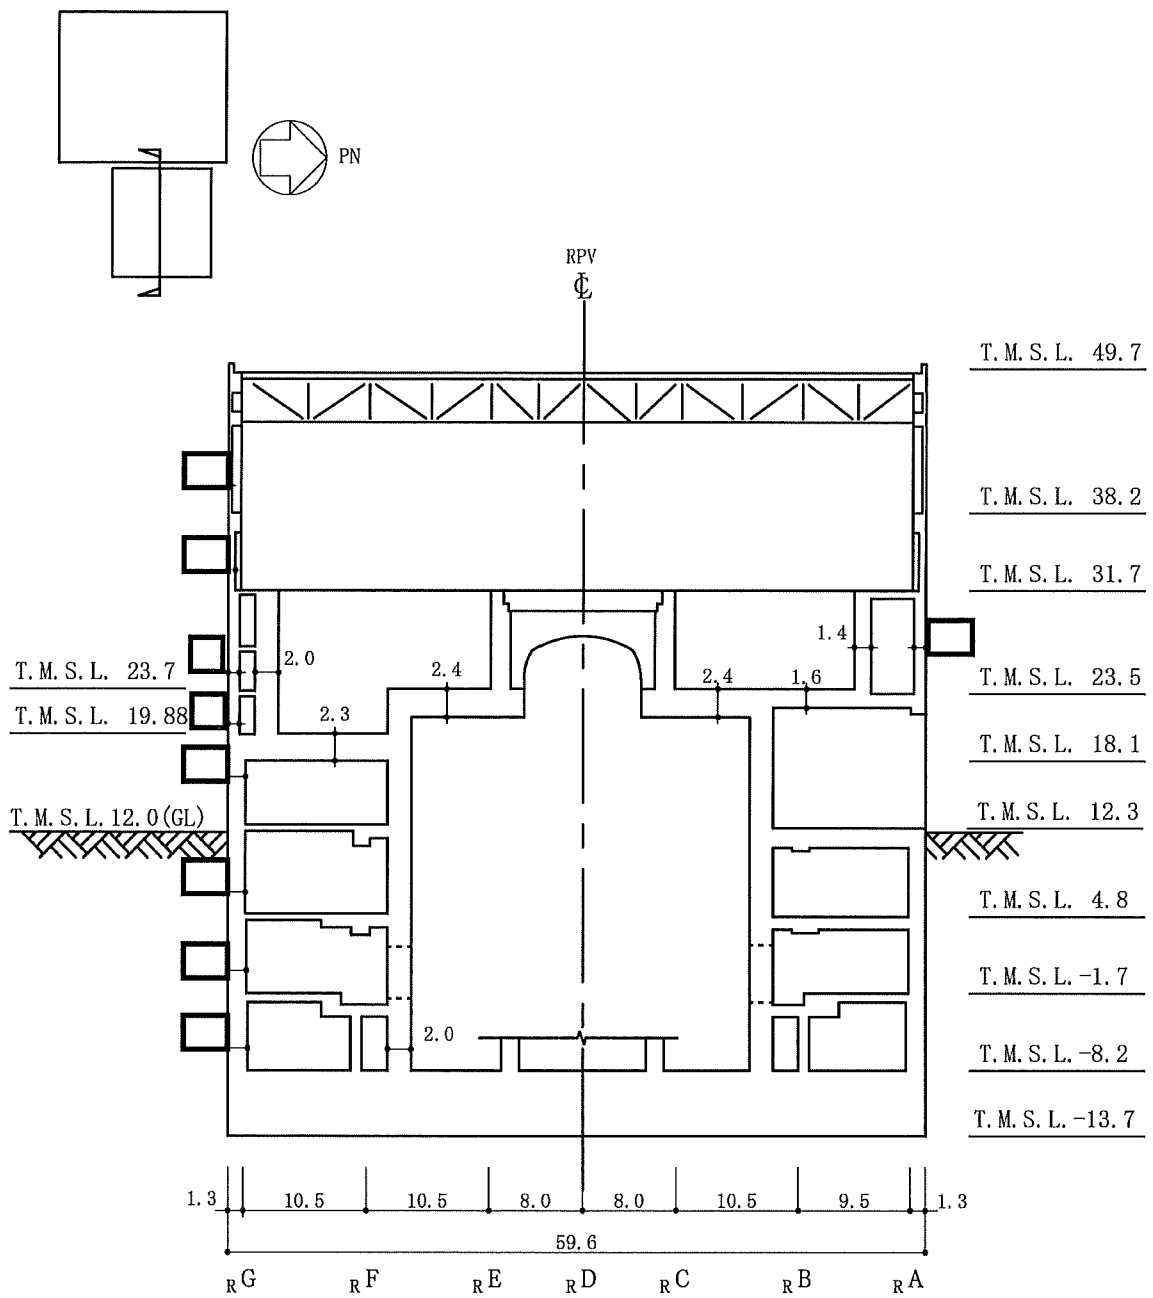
原子炉建屋の概略断面図 (EW 方向) (2/2) (単位 : m)
